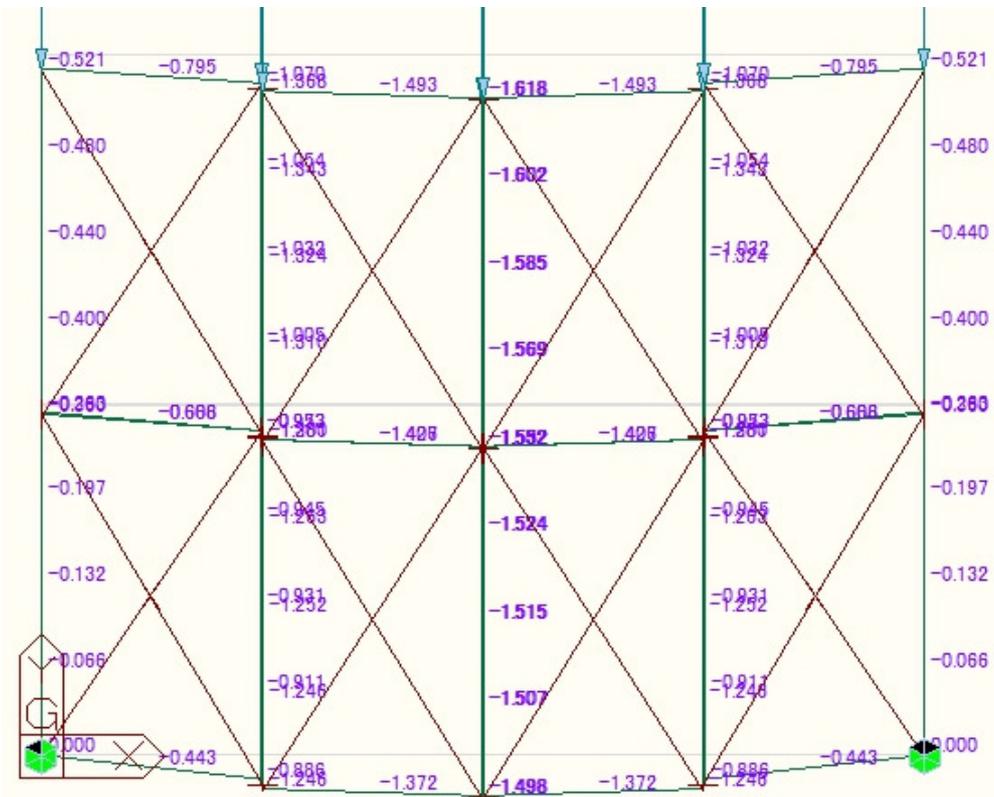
ケース2 Y方向 STS仕様 変形図(mm)
